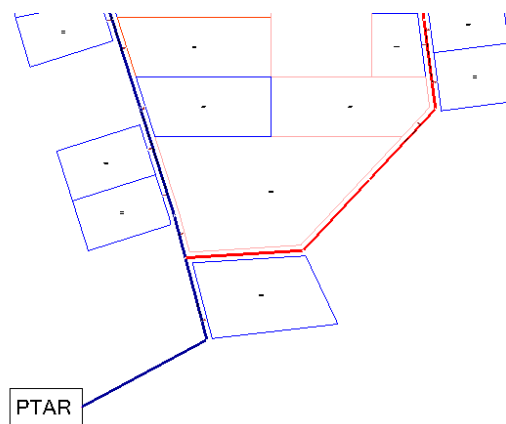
Ubicación tentativa de la planta de tratamiento.
